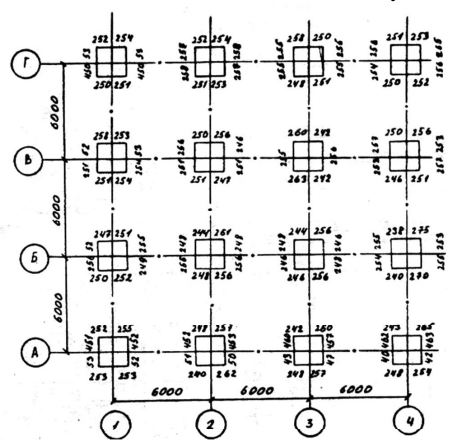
а) Исполнительная схема фундаментов под ж/б колонны.
